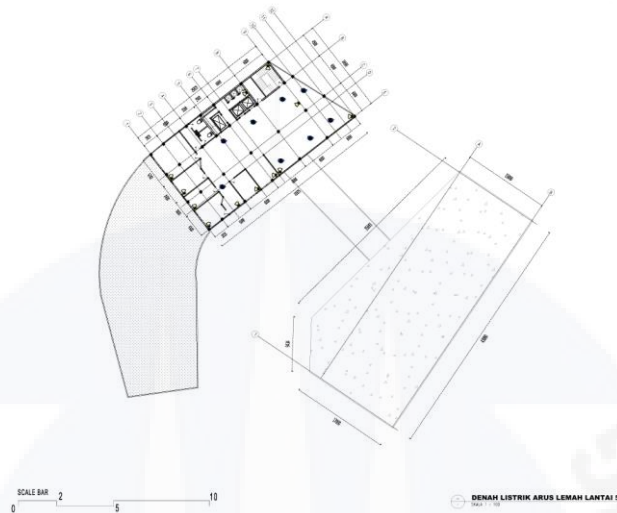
Denah Listrik Arus Lemah Lantai 4
